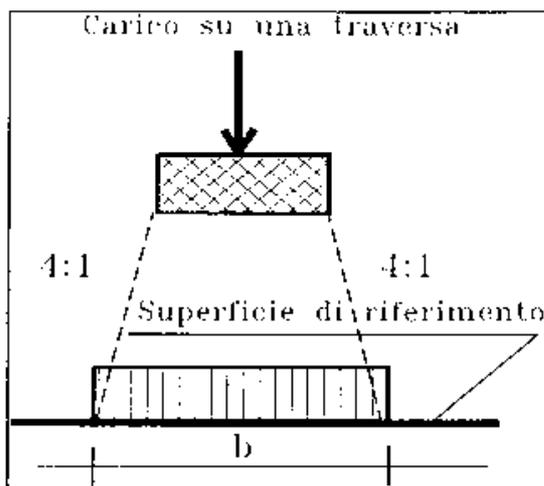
Distribuzione longitudinale dei carichi attraverso il ballast.
